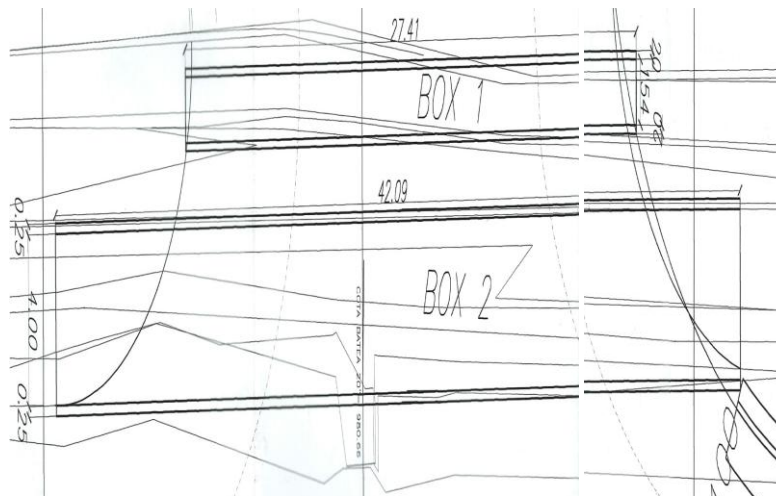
Planta de Box culvert canal aguas lluvias vía (box 2) y acequia El Rumor (box 1)
